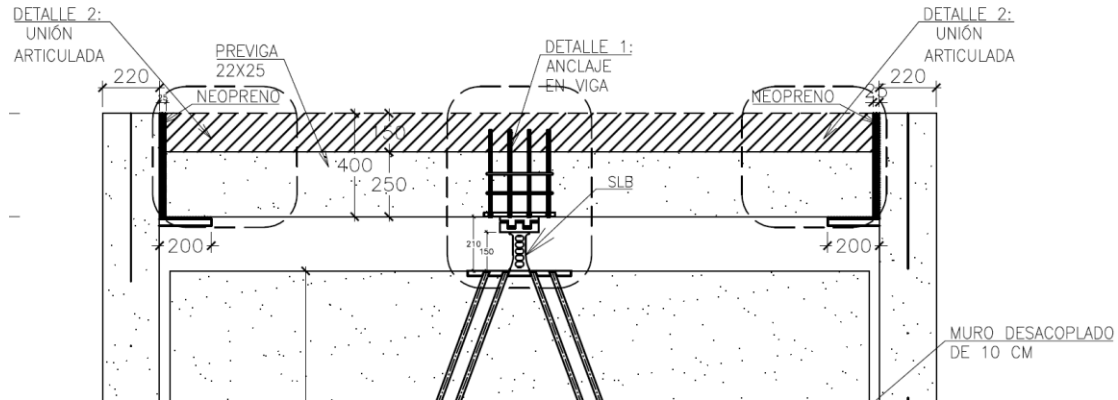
Conexión de disipador sísmico con viga de hormigón de módulo prefabricado
